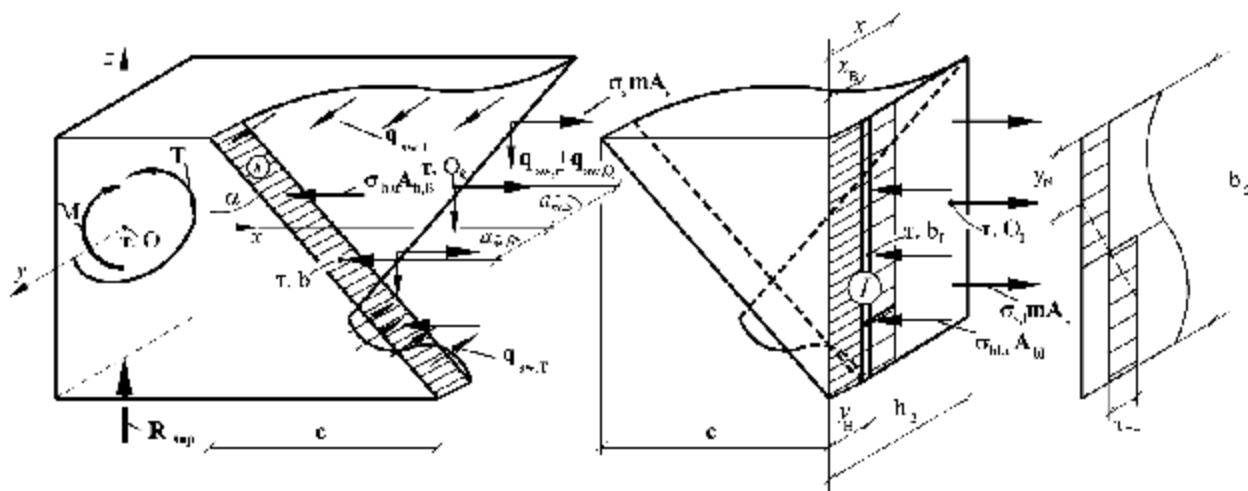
Расчетная схема сопротивления железобетонной конструкции при совместном действии изгибающего момента, крутящего момента и поперечной силы (случай 2):
